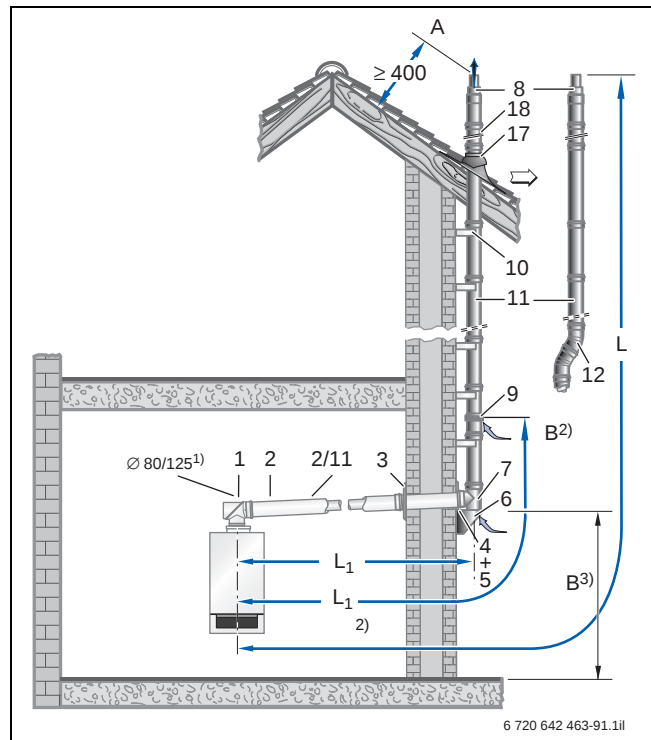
Montagevariante mit dem Bausatz GAF-K (Maße in mm)
